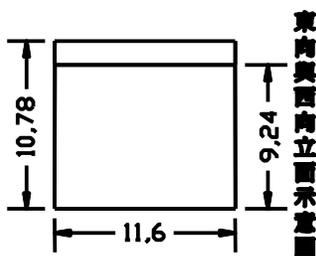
低層廠房東向與西向立面示意圖 單位 (m)
